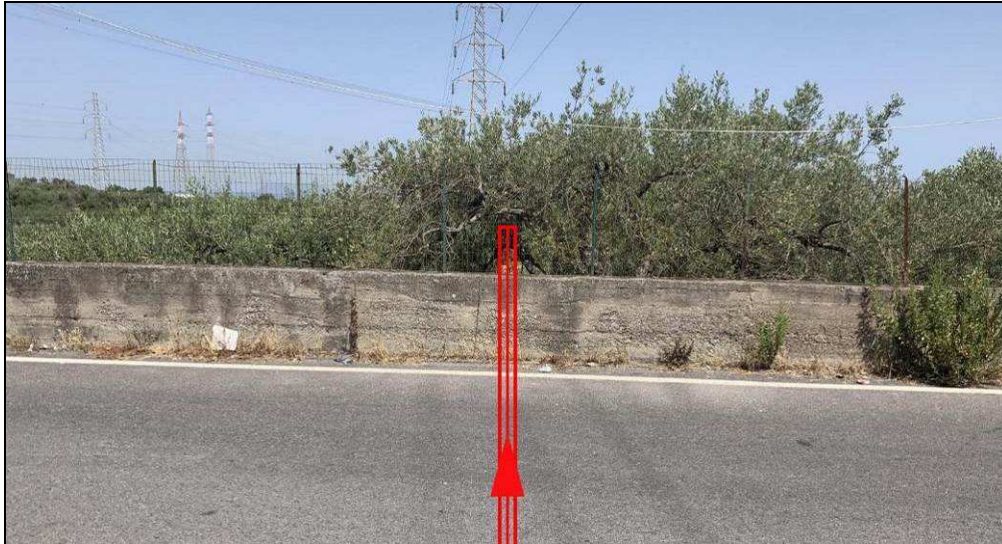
/E – Vista senso gas dell'attraversamento Via Pizzocroce (S.P. n.66) in trivellazione
